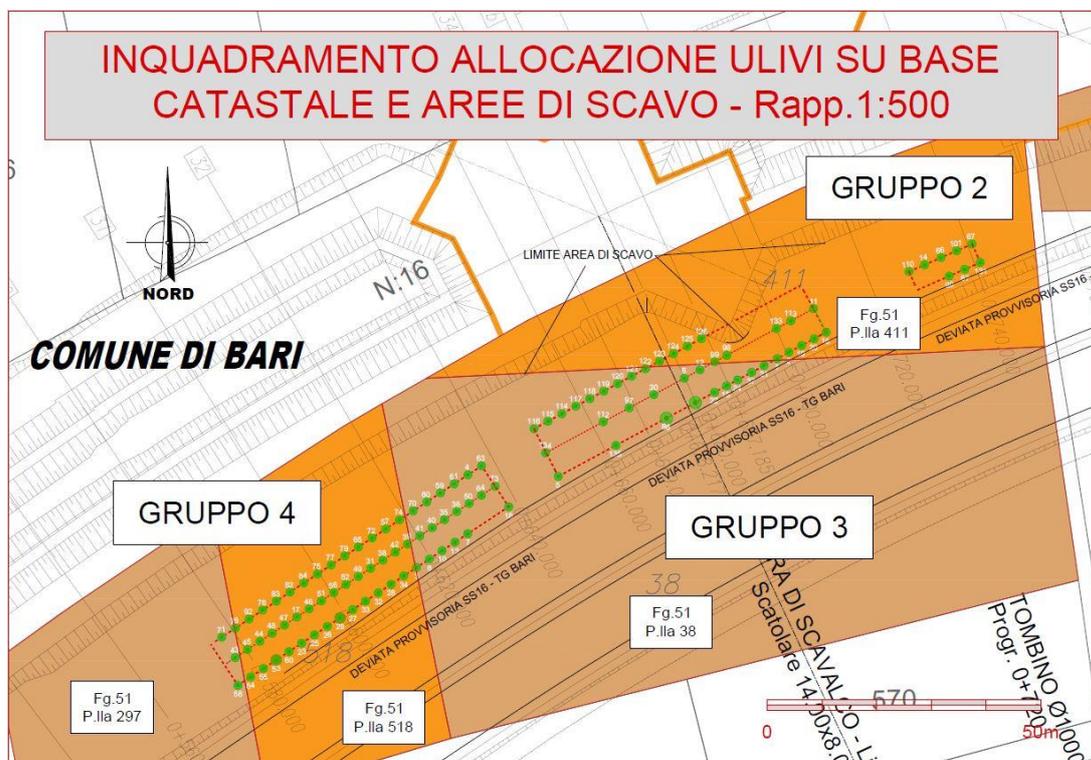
Planimetria attuale dei Gruppi 2, 3 e 4
